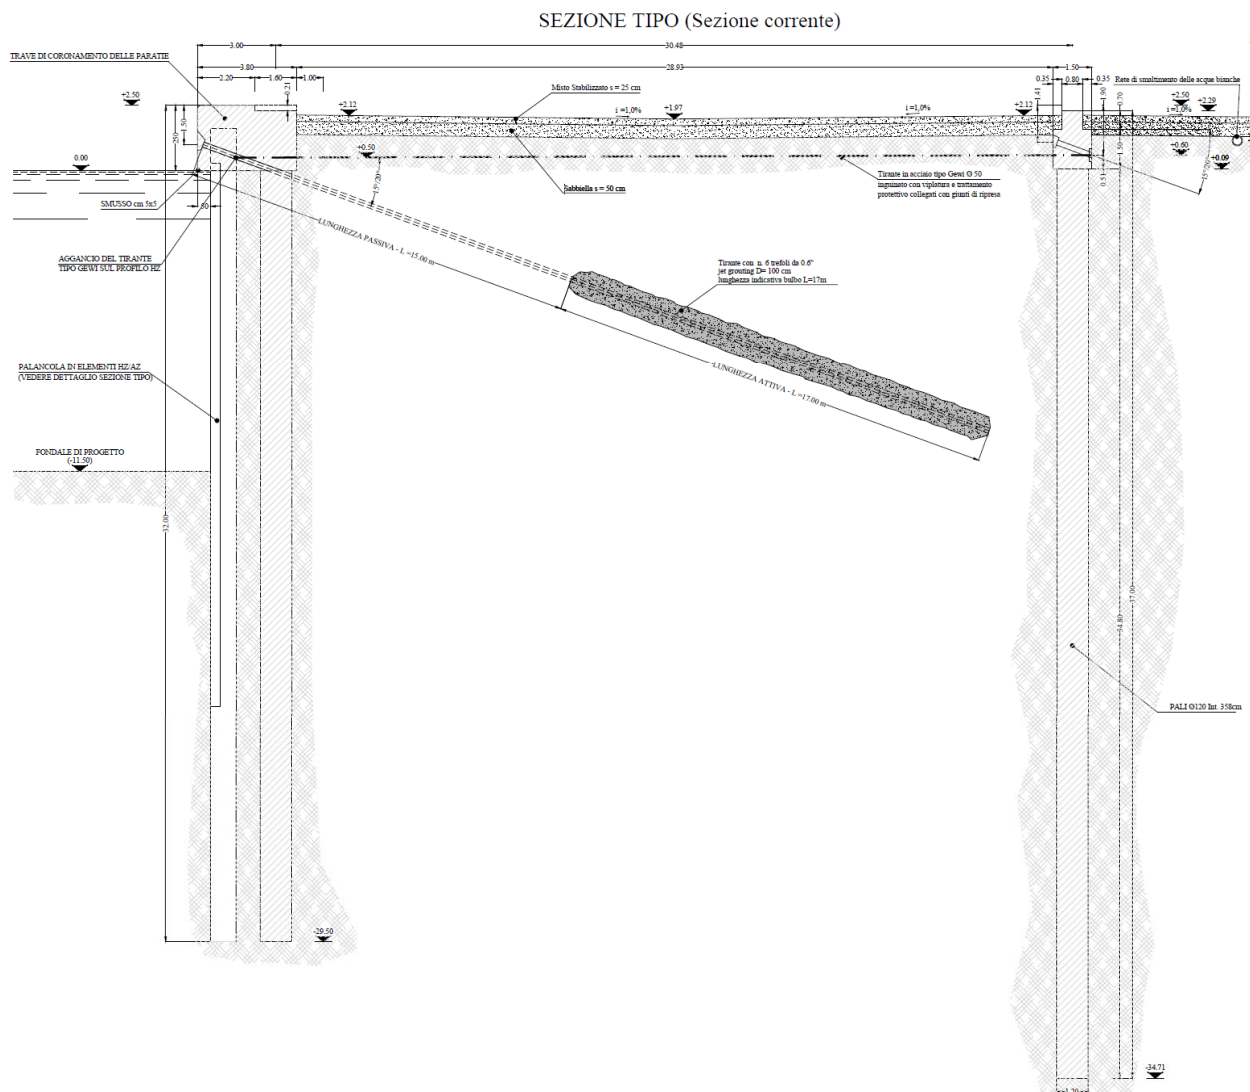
Stato di fatto - Sezione corrente (Estratto dalla 2ª Perizia di Variante – Sezioni Tipologiche: Tiranti con Jet Grouting)
